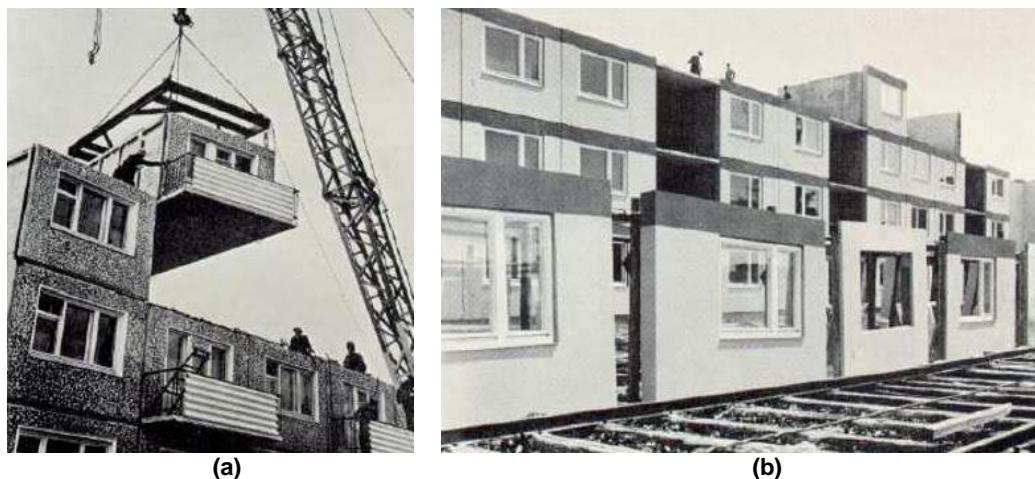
Construções com pré-fabricados em concreto leve: a) Rússia e b) Áustria (Rossignolo, 2003).
